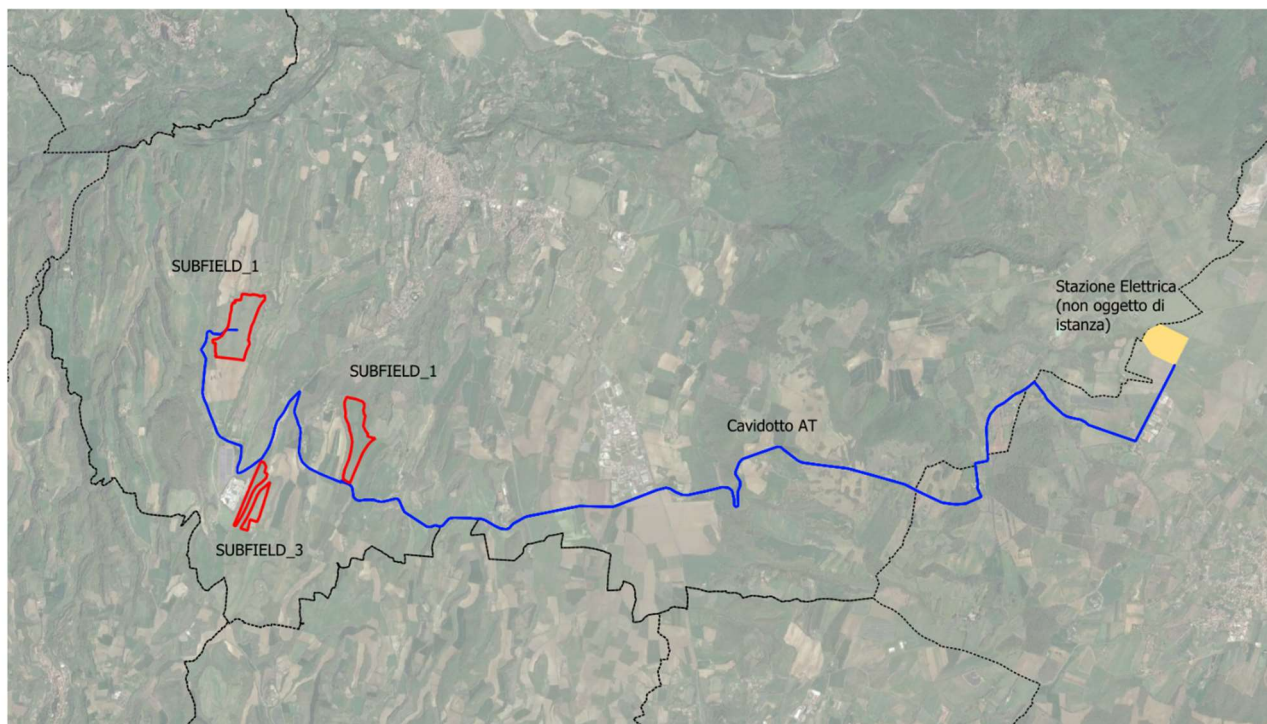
Planimetria su ortofoto dell’impianto agrovoltaiico
